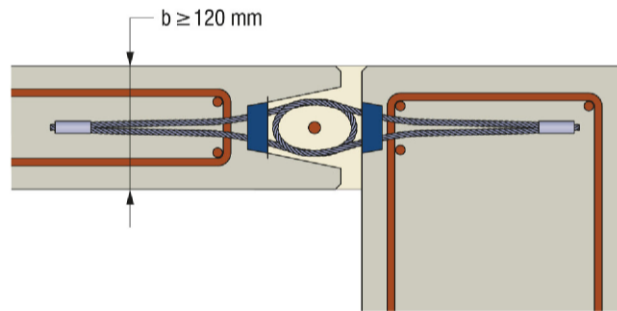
Wand – Wand – Eckverbindung - Regeldetail (*planer Einbau*)
